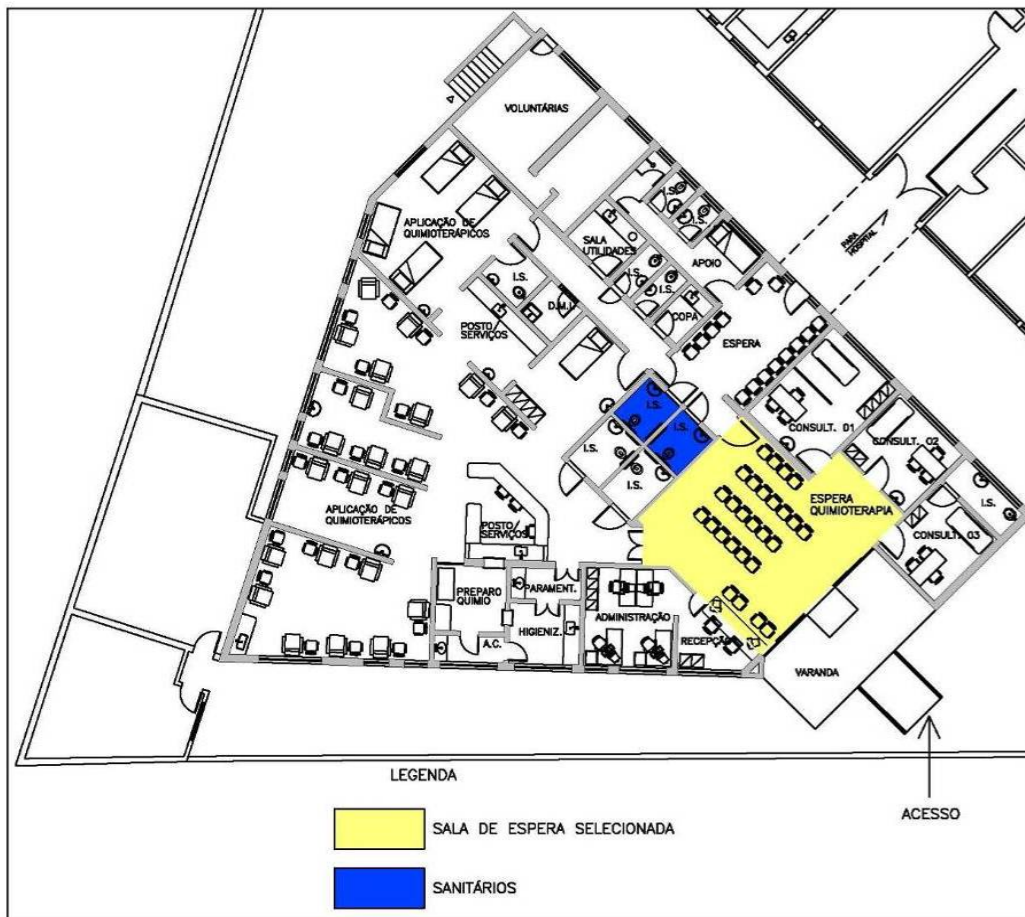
Planta arquitetônica do pavimento térreo da Unidade de Quimioterapia, Hospital Mário Penna
